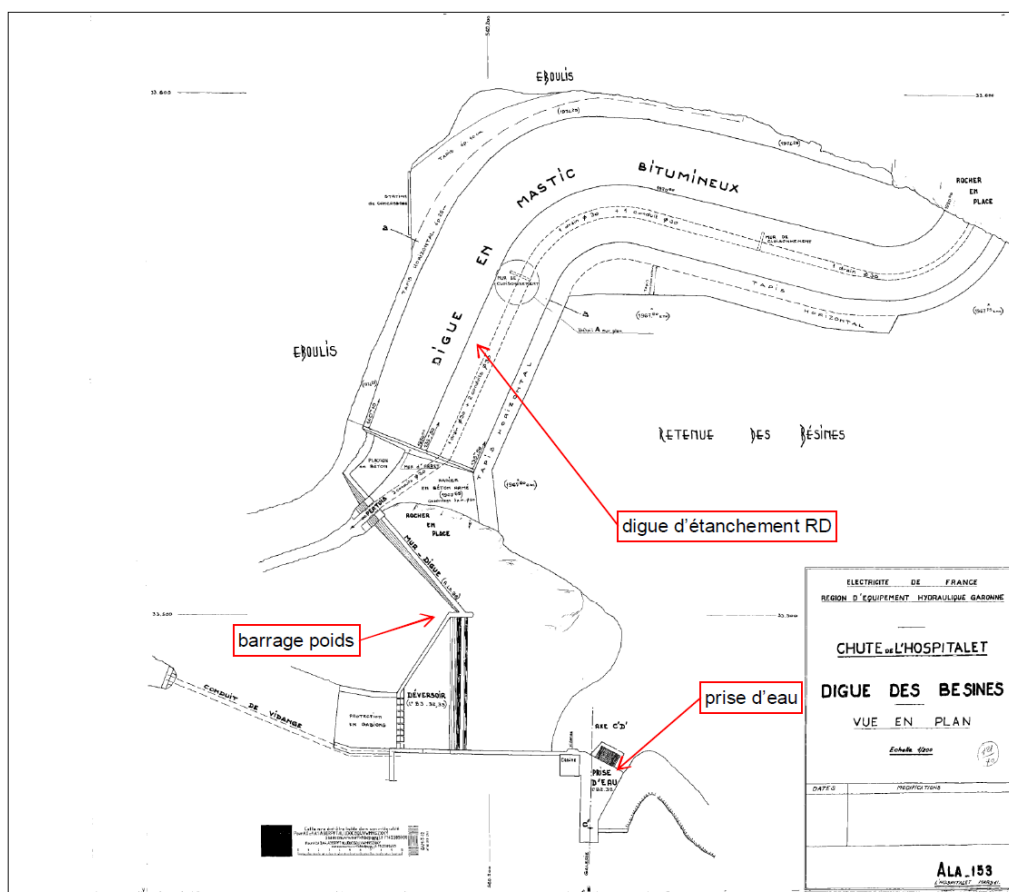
Vue en plan des ouvrages de la retenue des Bésines
